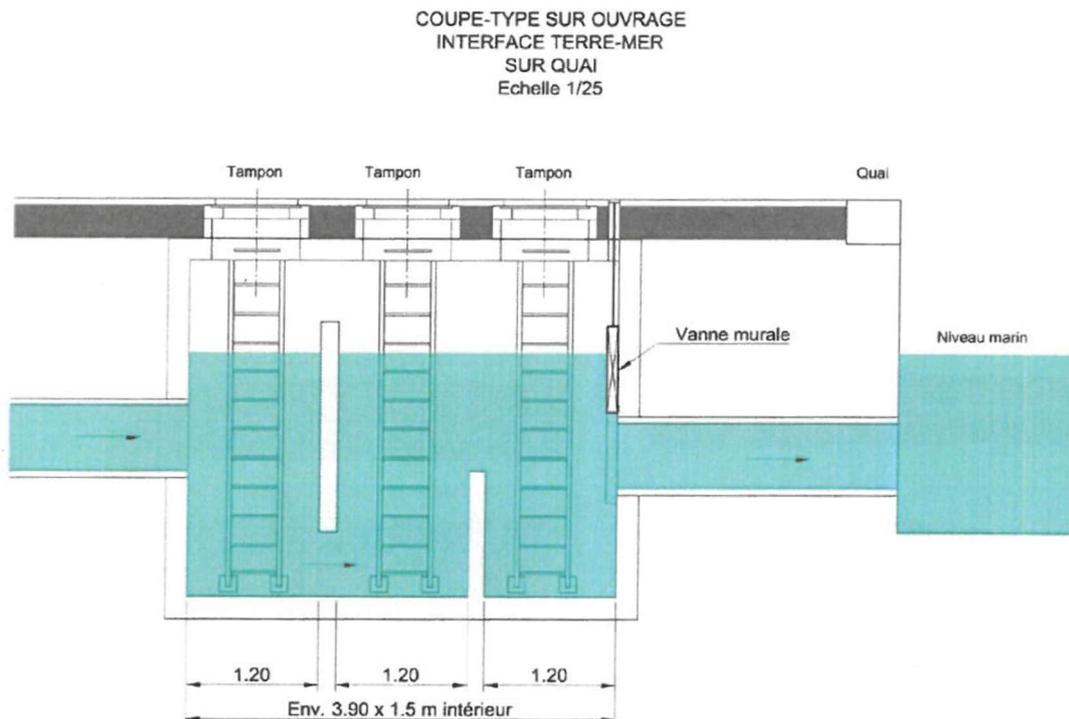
COUPE TYPE SUR OUVRAGE INTERFACE TERRE-MER SUR QUAI
